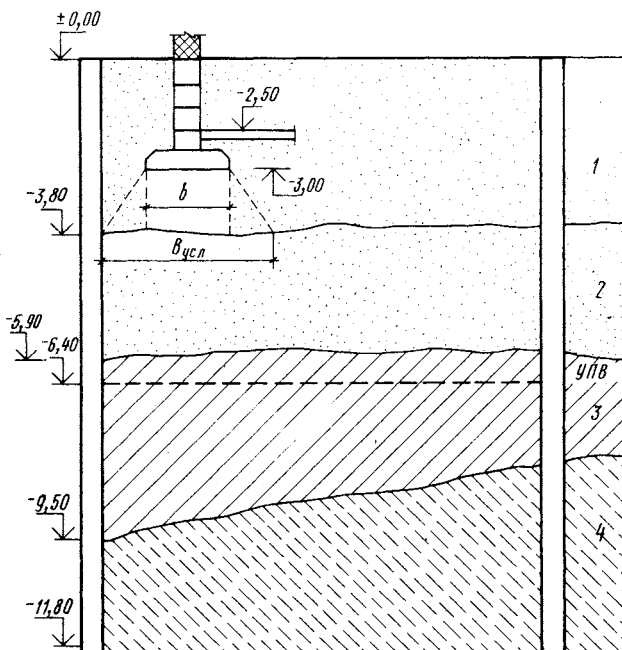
Геологический профиль строительной площадки (к примеру 5.1):
